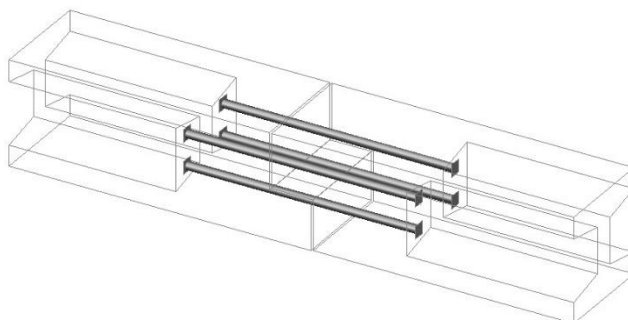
Ligação Viga – Viga por juntas em dente e barras
